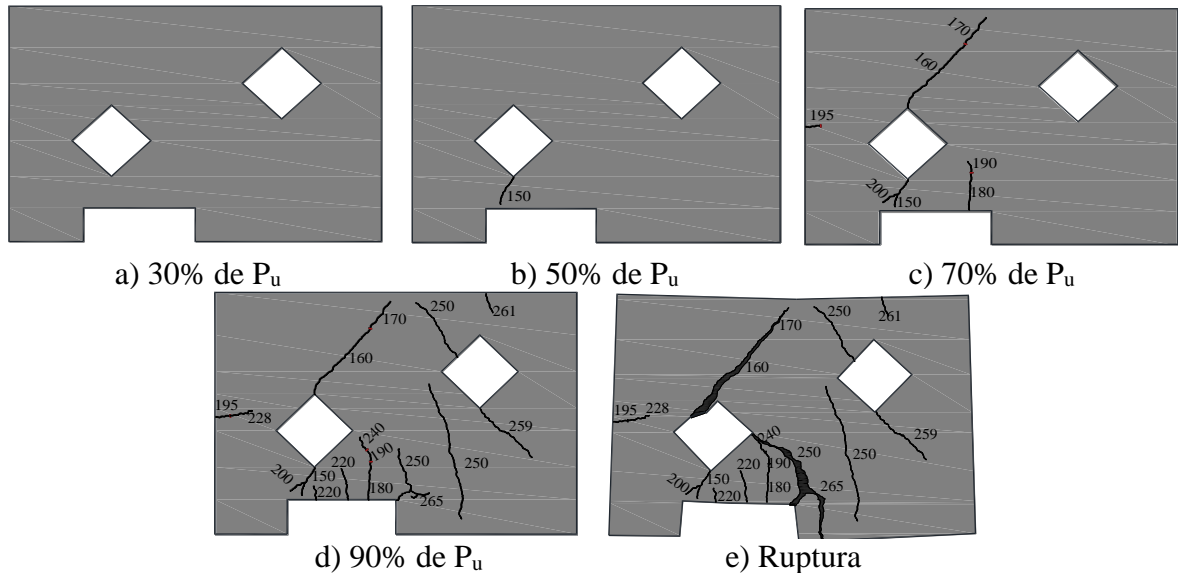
Mapa de fissuração DB1-W-H2-U-1 (força indicada em kN)
